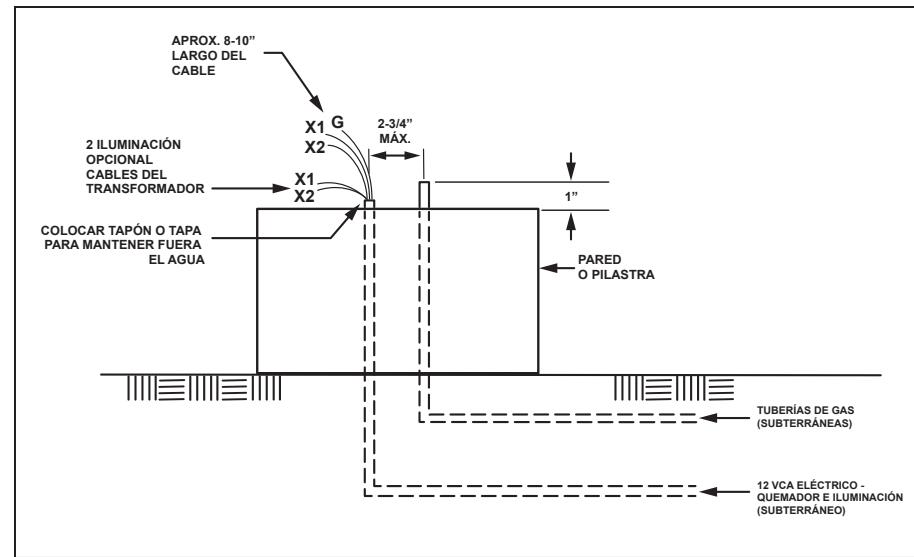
Tuberías y cableado en el candelabro montado en el piso
